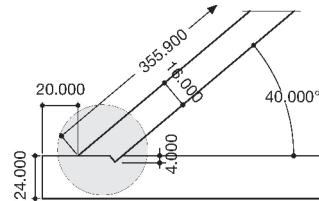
zeigt einen Ausschnitt aus einer CAD-Werkzeichnung für ein einfaches Hängewerk.
